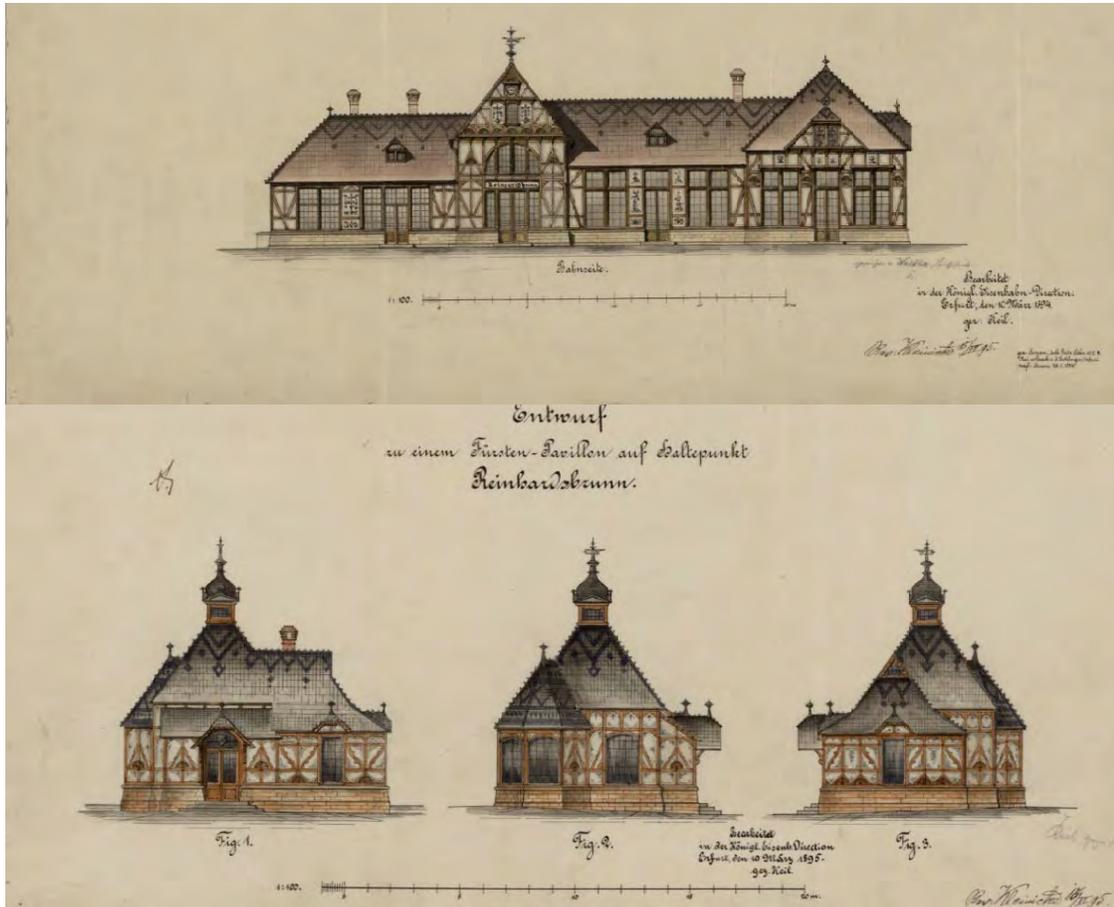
Entwurf Empfangsgebäude Bahnhof Reinhardsbrunn und Fürstenpavillon, 1895
